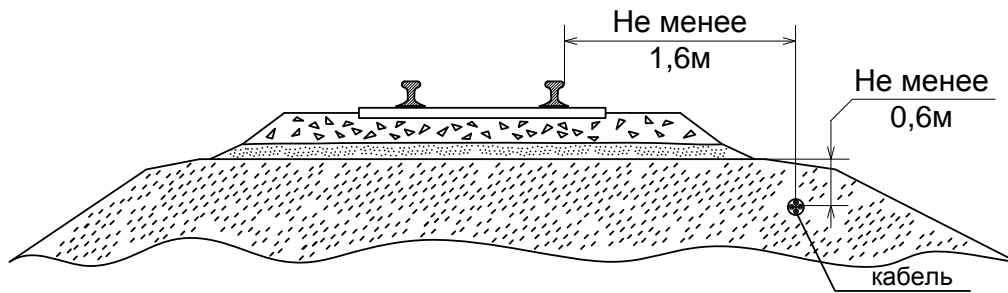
Укладка кабеля на однопутных участках вдоль железнодорожного пути на перегонах
